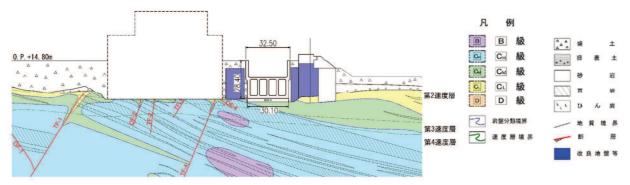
地盤改良体の配置図(海水ポンプ室横断, C-C 断面)
